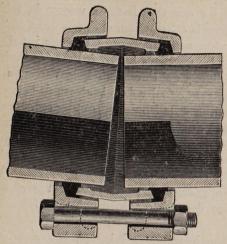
Angle des deux axes de tuyaux joint (Gibaut).
